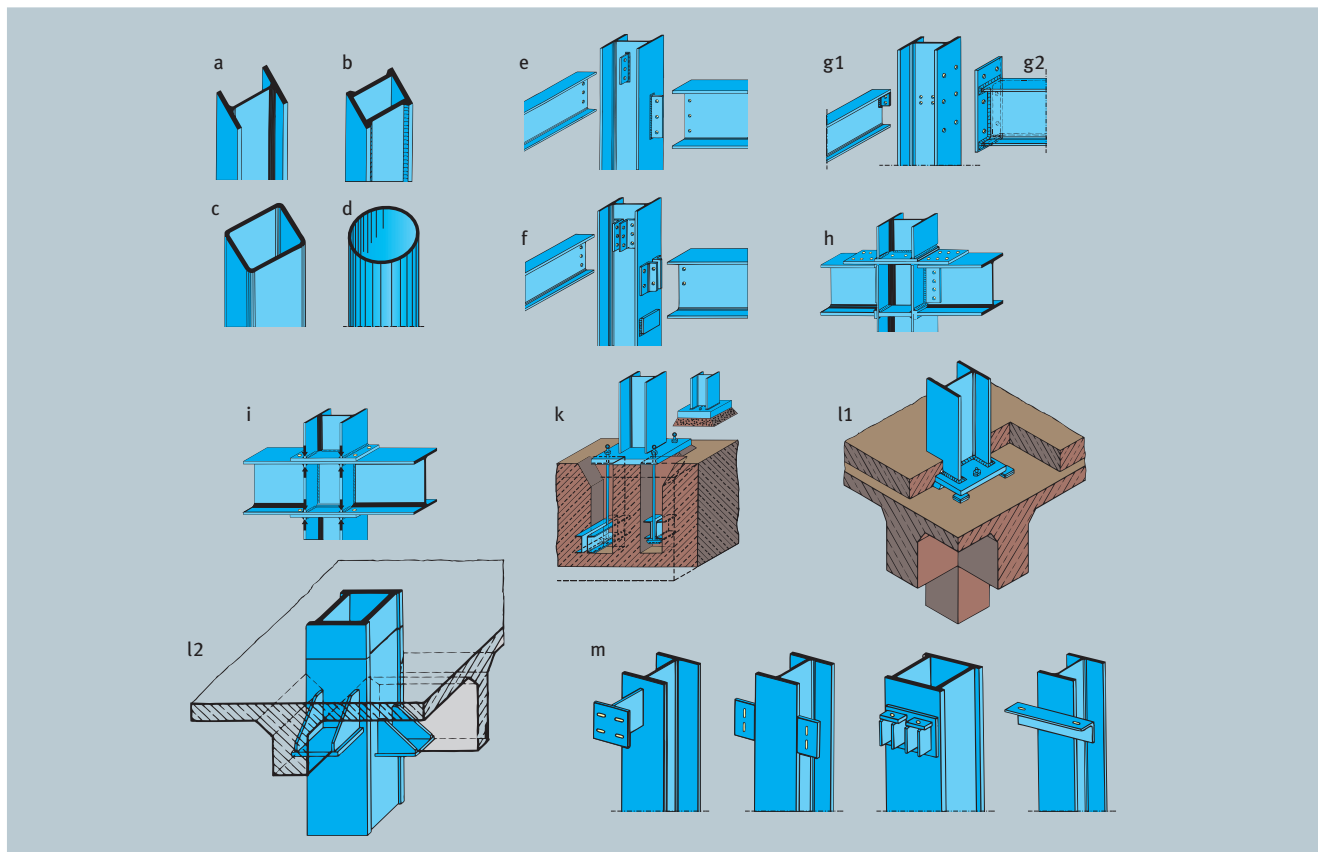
a bis m: Stützenprofile, Anschluss- und Lagerungsdetails
